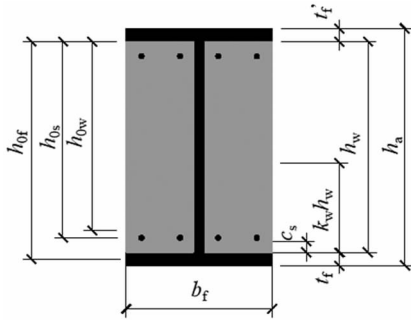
无翼板 PEC 梁混凝土最大裂缝宽度计算参数示意
